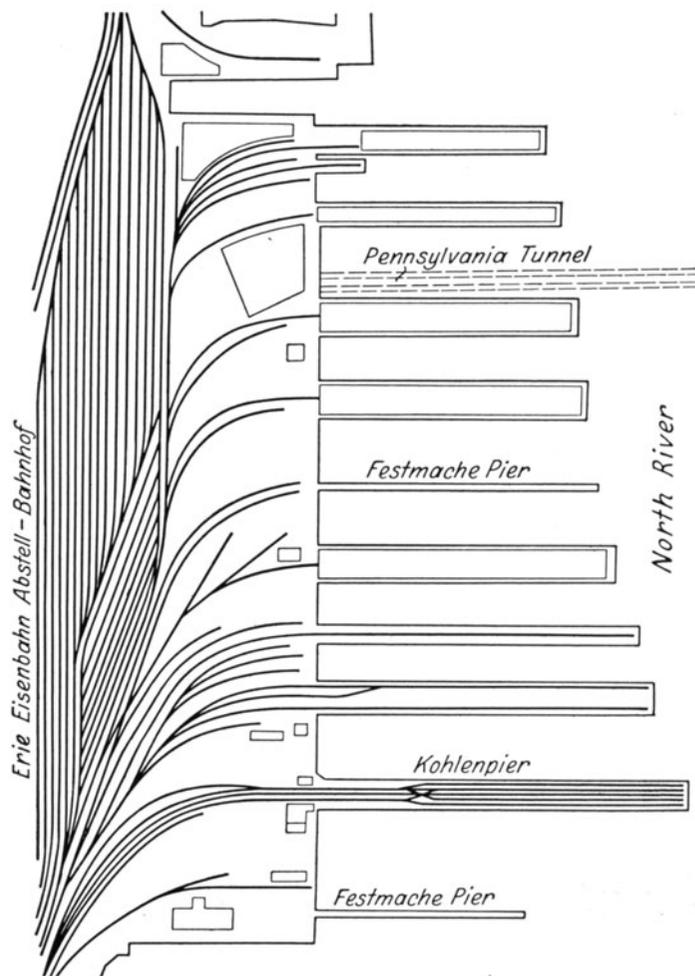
Abstellbahnhof der Erie-Eisenbahn mit Pieranschlüssen.
